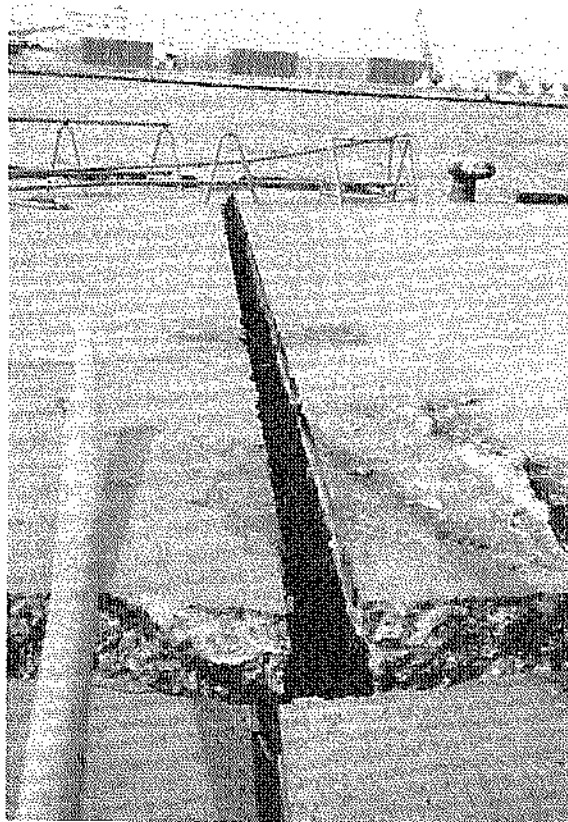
ケーソン目地開き状況 (第2埠頭地区, ⑥西側岸壁(-9.0m))
